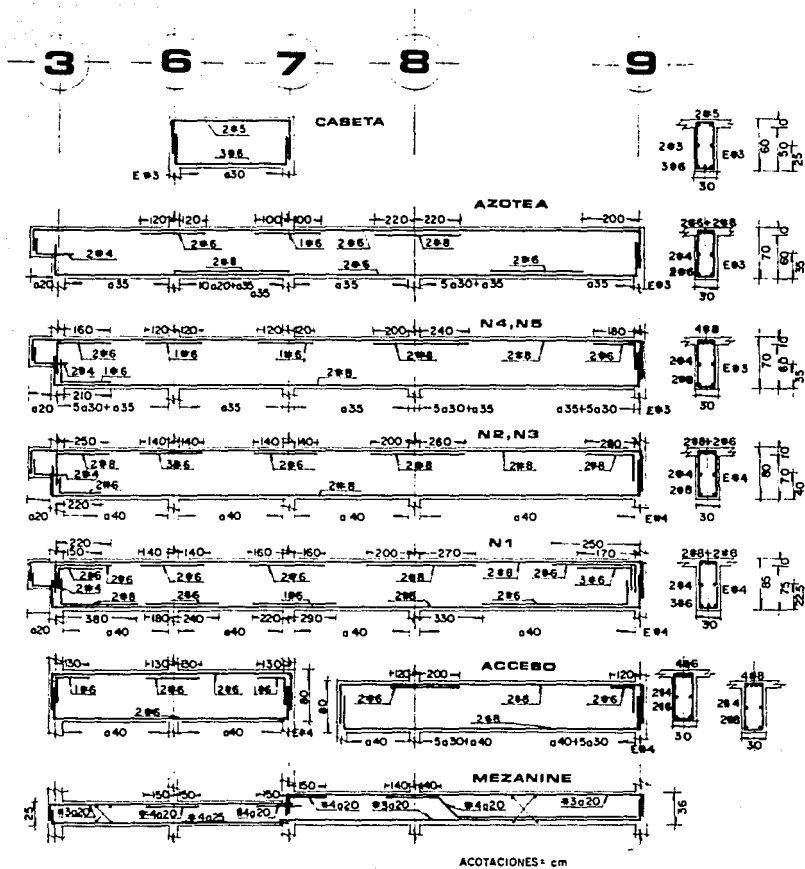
ARMADOS DE VIGAS Y LOSAS DEL EJE C
